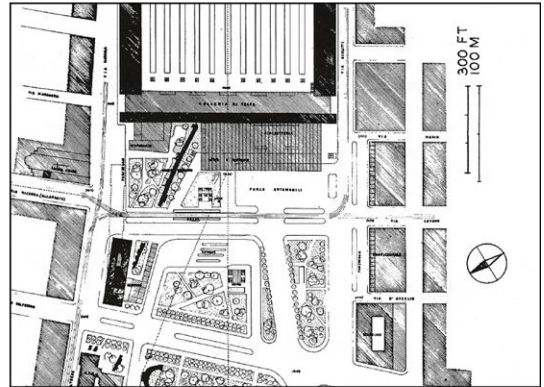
Grundriss Umgestaltung nach 1945, Montuori, u.A. aus Rossi 2012
